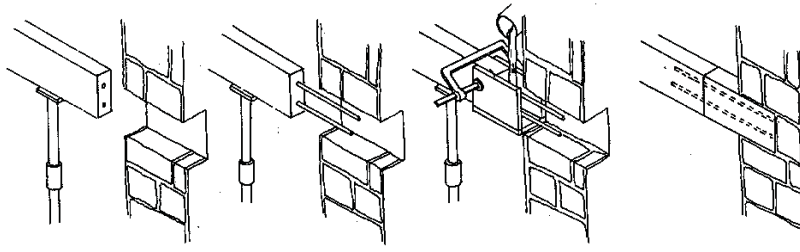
Reparação da zona de apoio de uma viga com argamassa epoxídica e armaduras.
